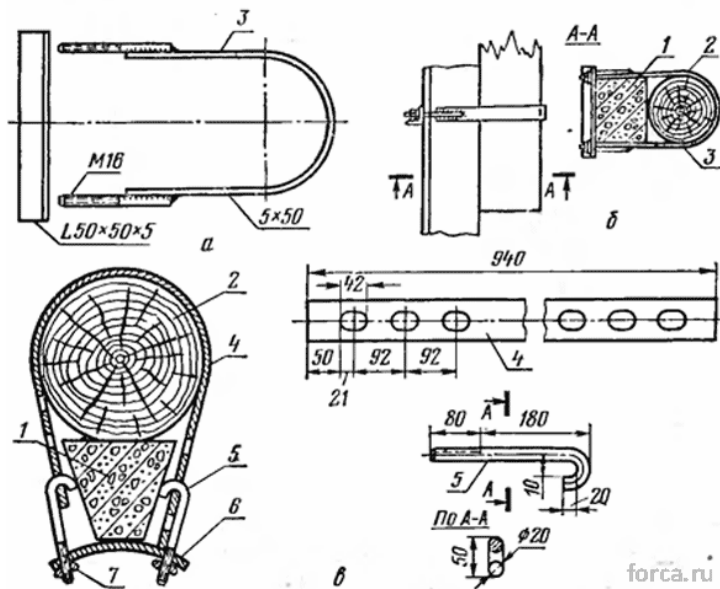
Хомуты для соединения деревянных стоек с железобетонными приставками:
